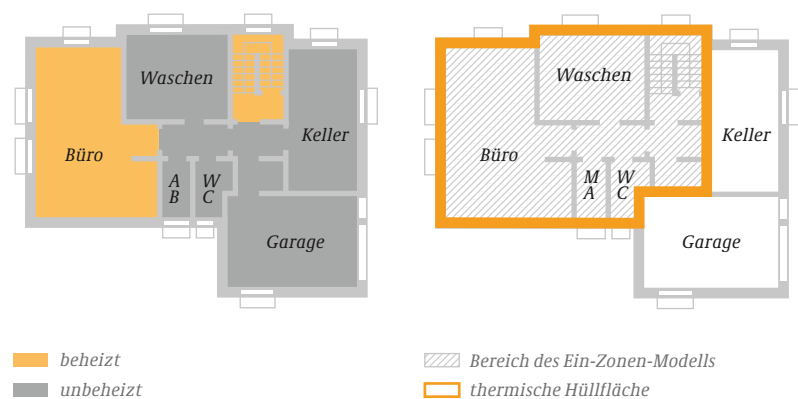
Grundriss beheizte und unbeheizte Bereiche, thermische Hüllfläche
